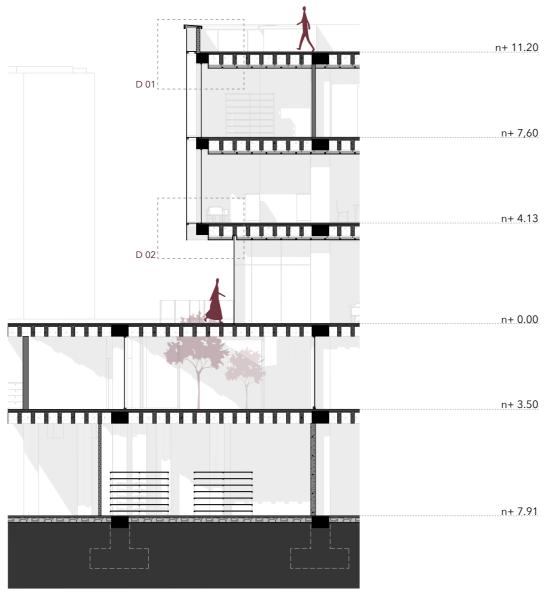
Sección transversal detalle. Fuente: Elaboración propia
